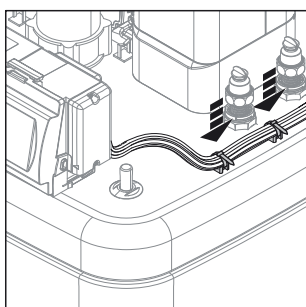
Fissare i cavi al serbatoio ad accumulo.
